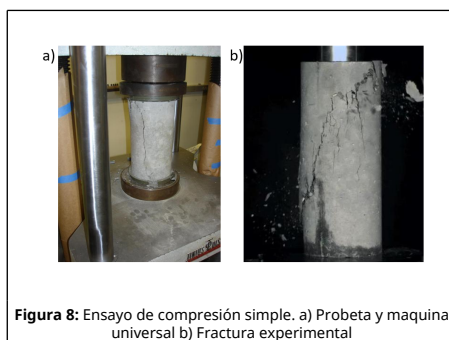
Ensayo de compresión simple. a) Probeta y maquina universal b) Fractura experimental
